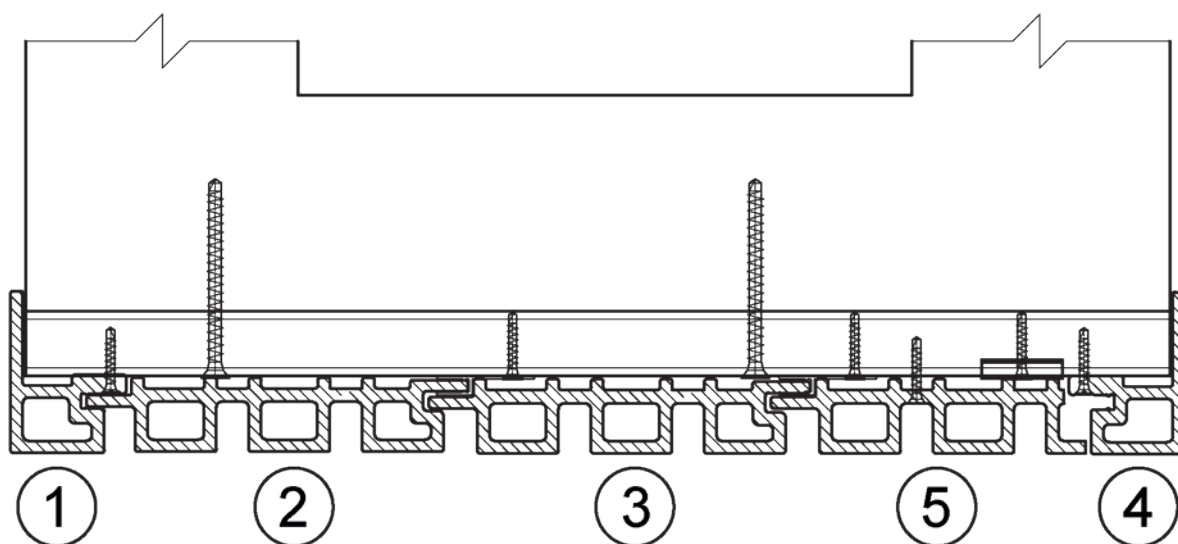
Montaje de la fachada en las partes rectas del edificio
